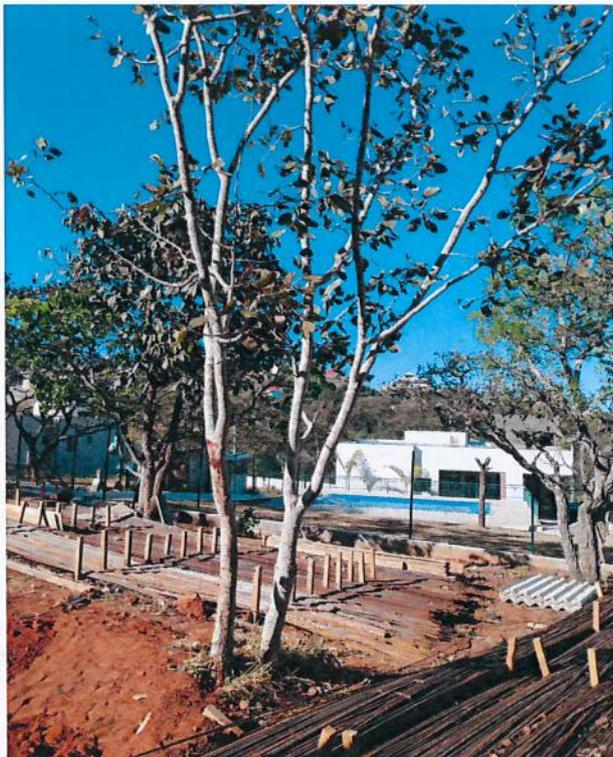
Jatobá do cerrado, situado na lateral direita deverá ser preservado.
